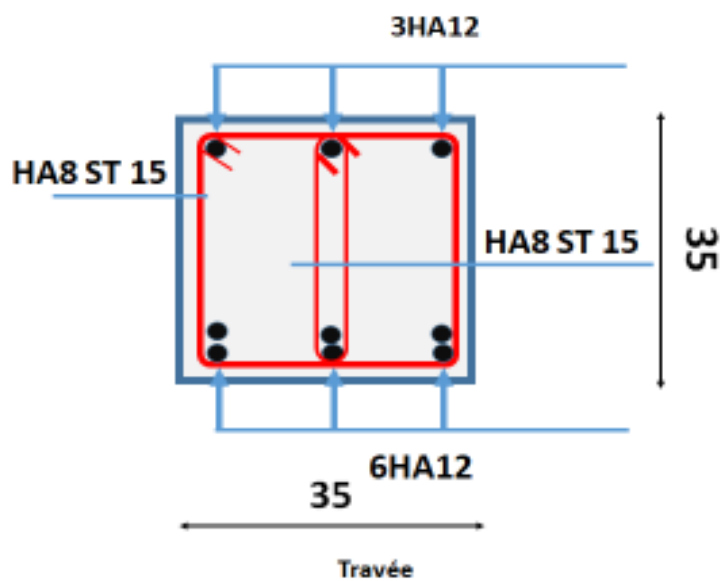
Schéma de ferrailage des poutres secondaires.
